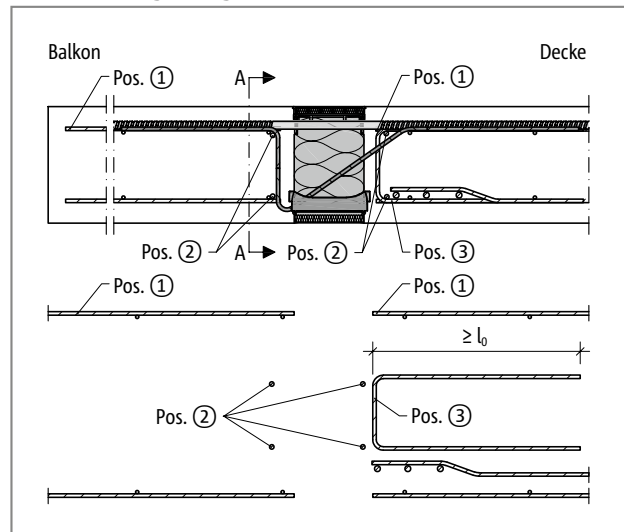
Schöck Isokorb® CXT Typ K: Bauseitige Bewehrung bei indirekter Lagerung
